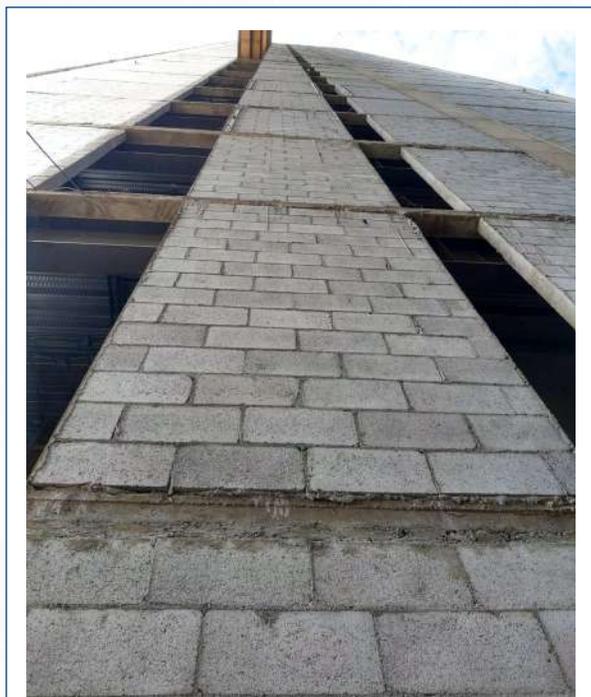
Muro divisorio con block de concreto con refuerzo interior
